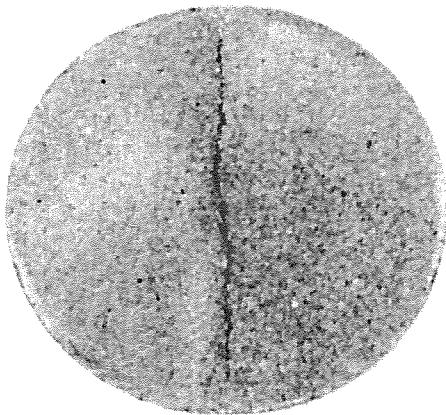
Aspecto de la fractura durante el ensayo de compresión diametral.
